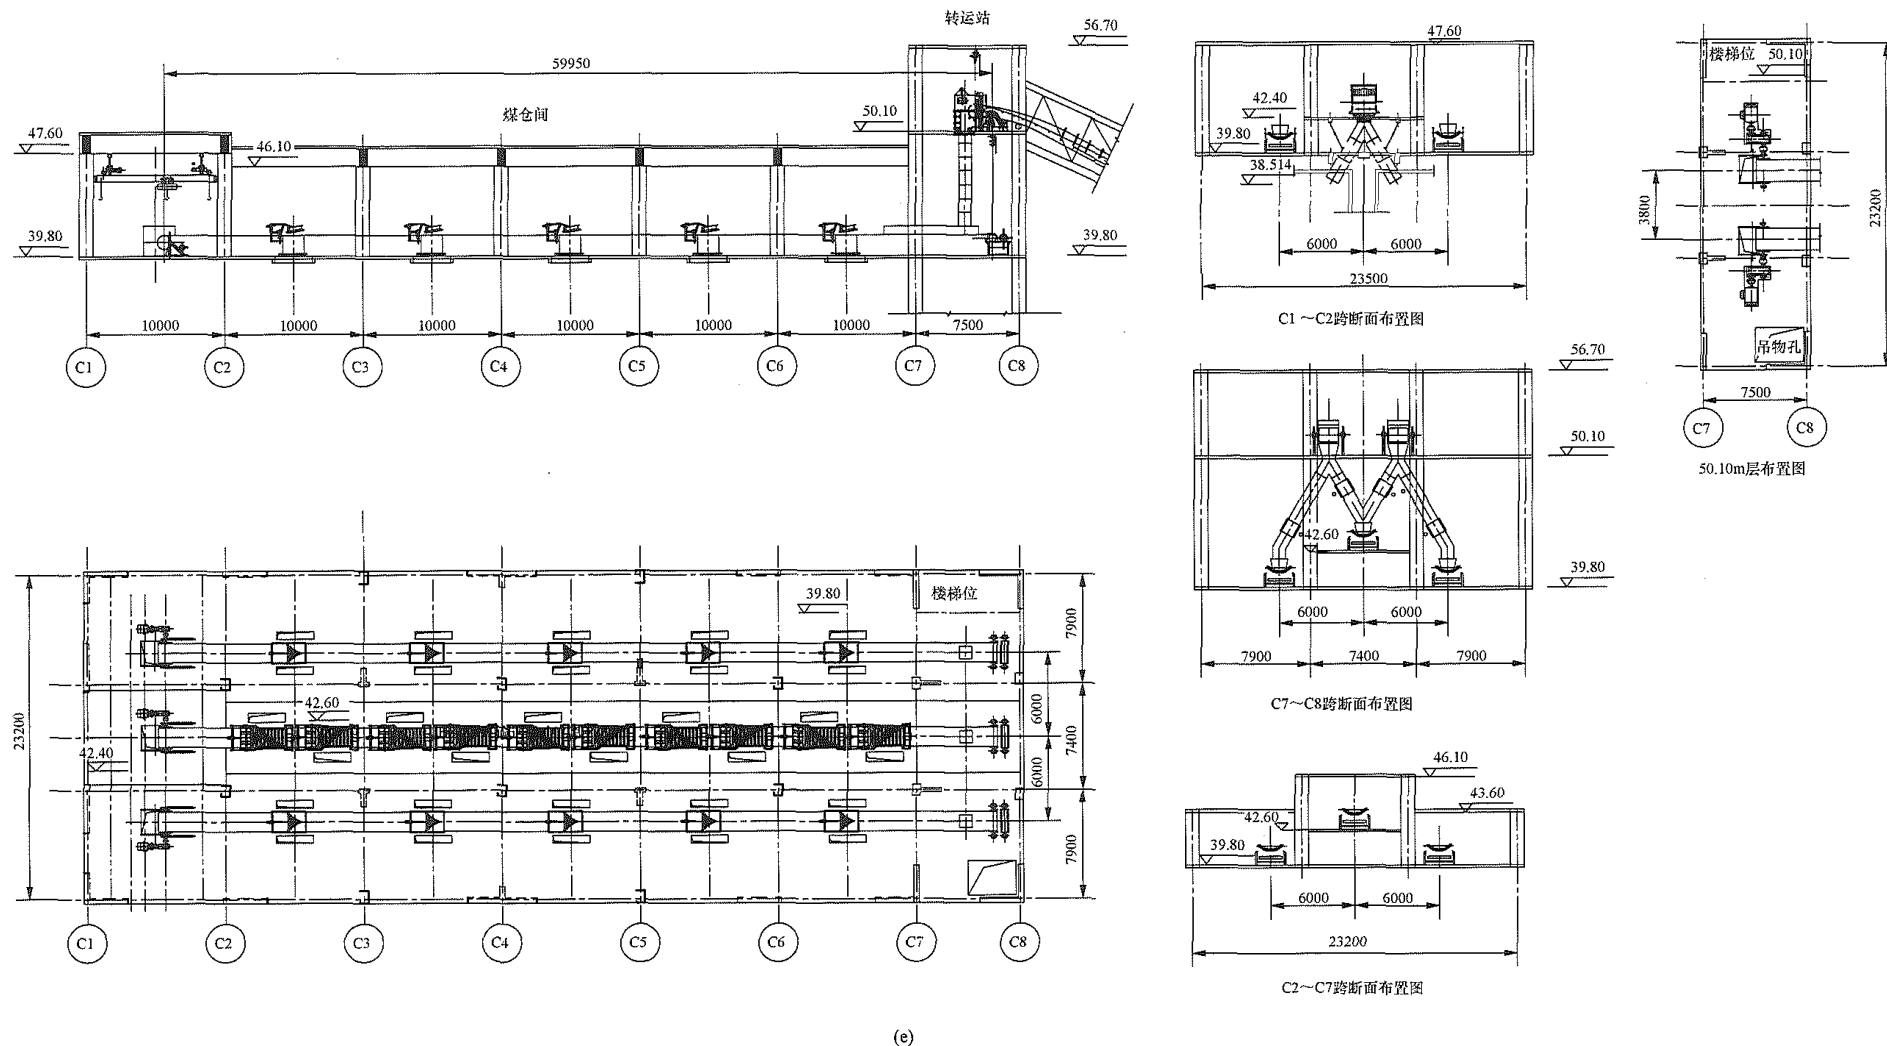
MPS 轮式磨煤机侧煤仓方案平面布置示意图 (五)
